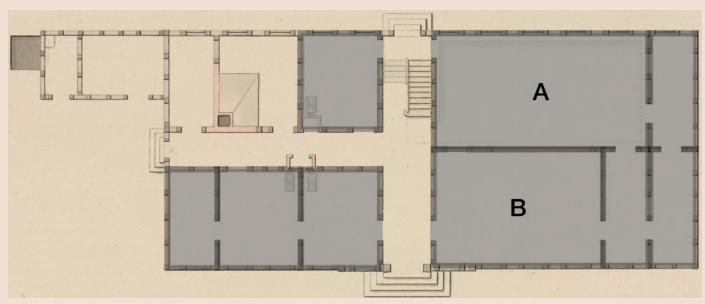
Rekonstruktion des Grundrisses nach 1842: A. Laboratorium, B. Laboratorium
